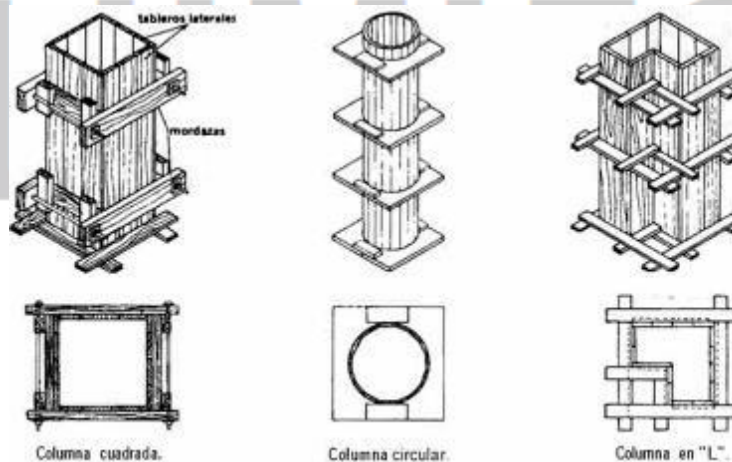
Diseño de encofrado para columnas, Fuente Sena.
